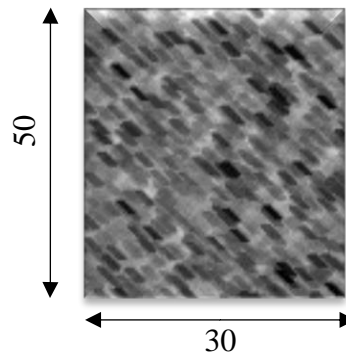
Section transversale de la poutre $30 \times 50 \text{ cm}^2$
